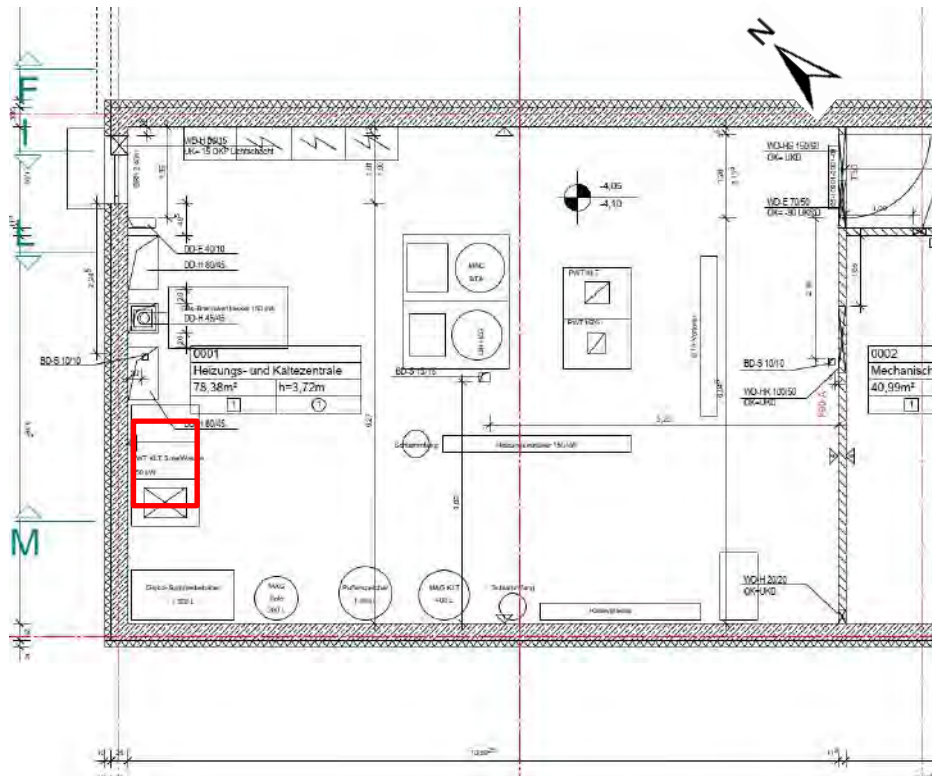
Grundriss des Heizungsraumes. Tatsächliche Anordnung der Einrichtungen leicht abweichend; Lage des Glykoltanks rotes Rechteck. Ausschnitt aus [22]
